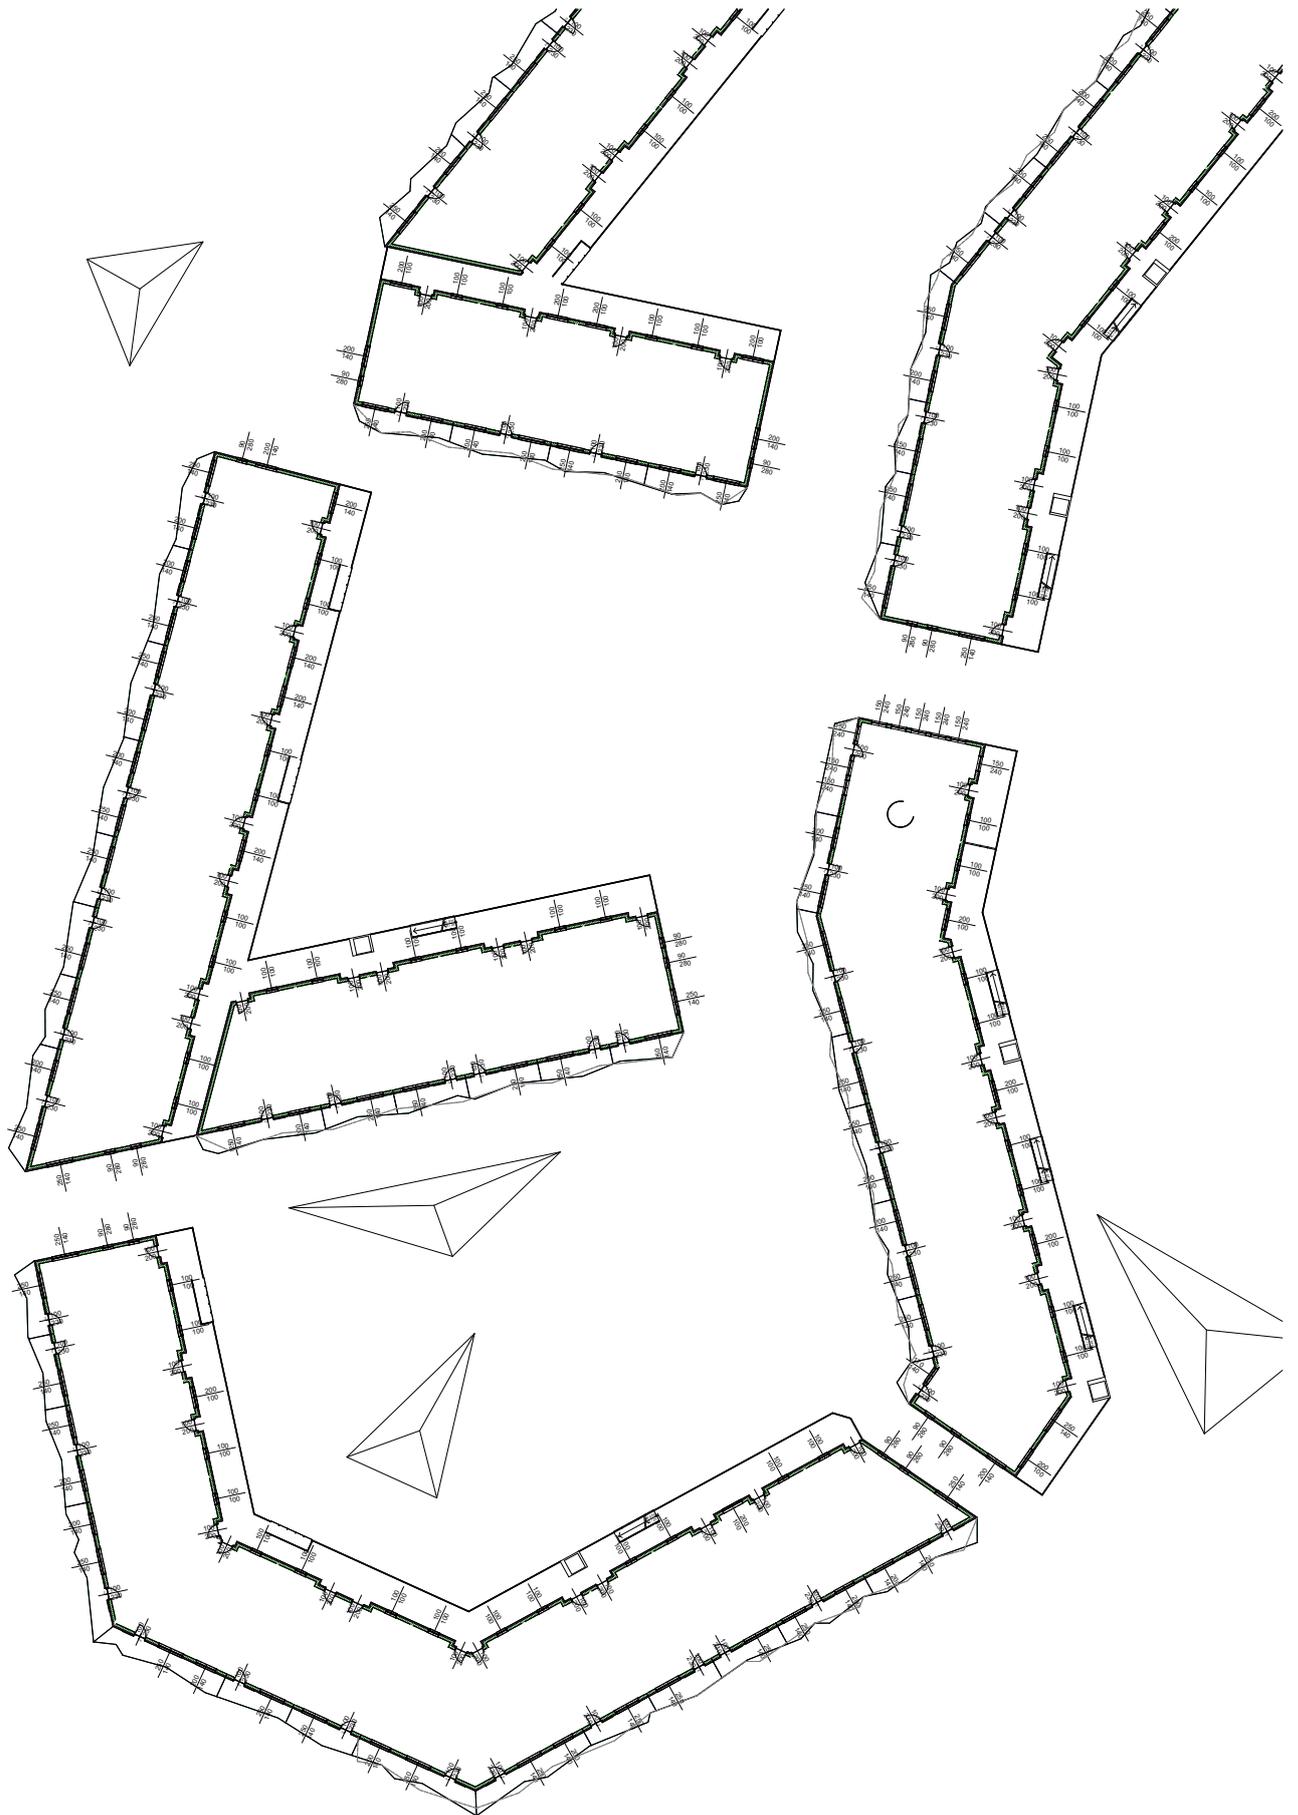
| Grundriss Kindergarten Maßstab 1:200
